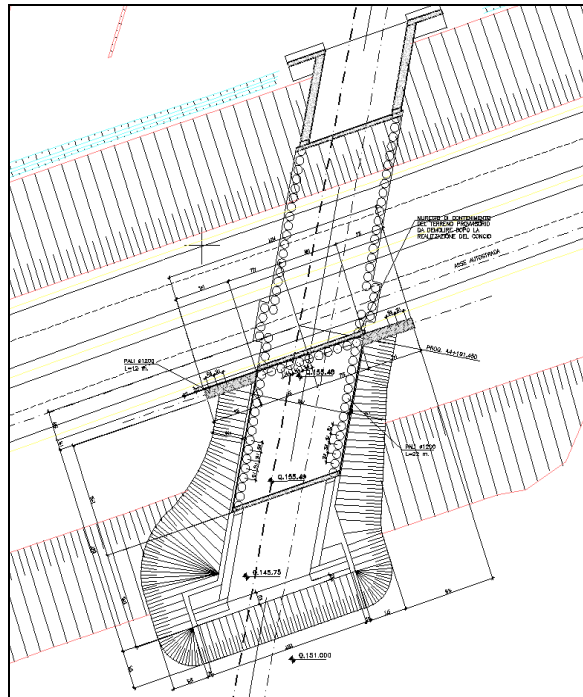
Planimetria fasi realizzative dell'opera. Fase 5
